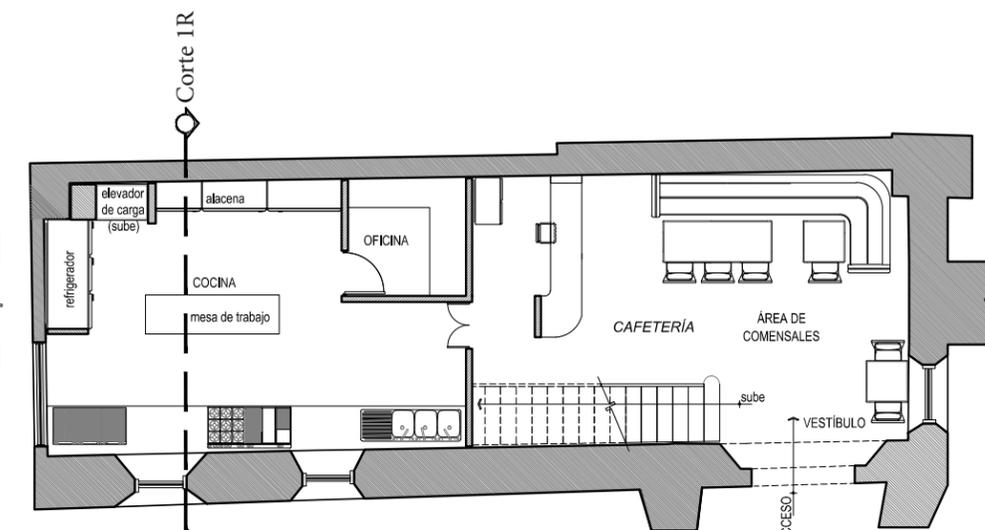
Planta de restauración de molino de abajo - Primer nivel.
